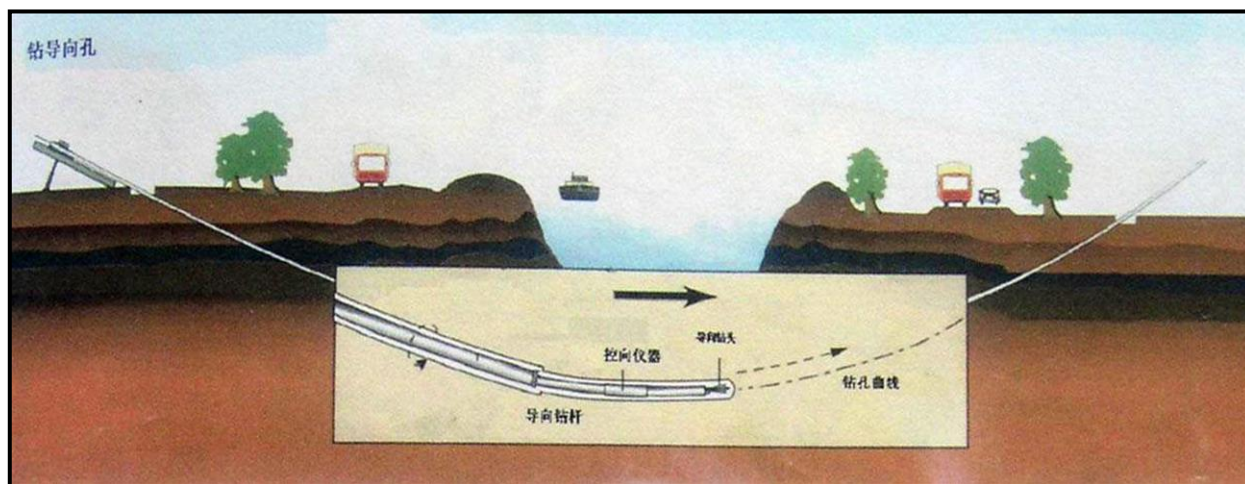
定向钻穿越施工钻导向孔过程断面示意图
